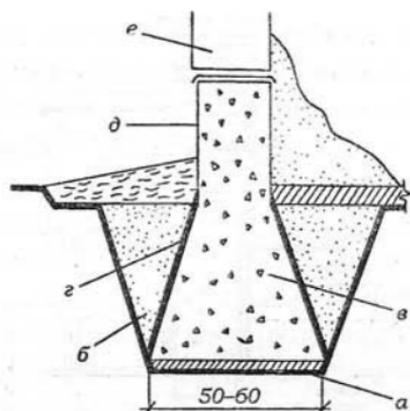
Устройство бетонного или бутобетонного фундамента в условиях тяжелых грунтов (размеры в см):
